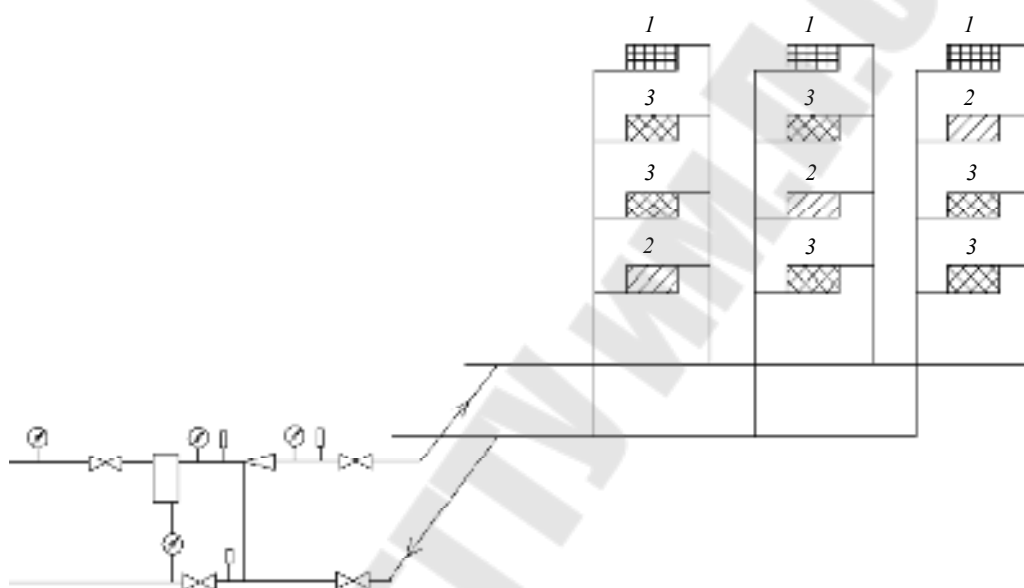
Схема установки дроссельных шайб в двухтрубной схеме отопления:
